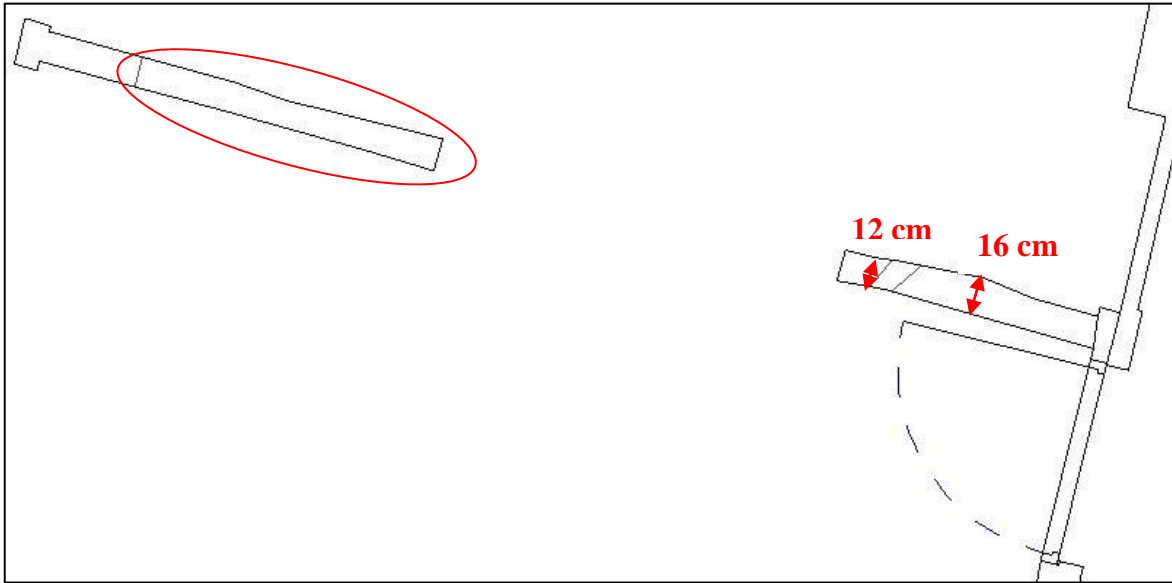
murs à l'épaisseur irrégulière sur un plan depuis Revit.
